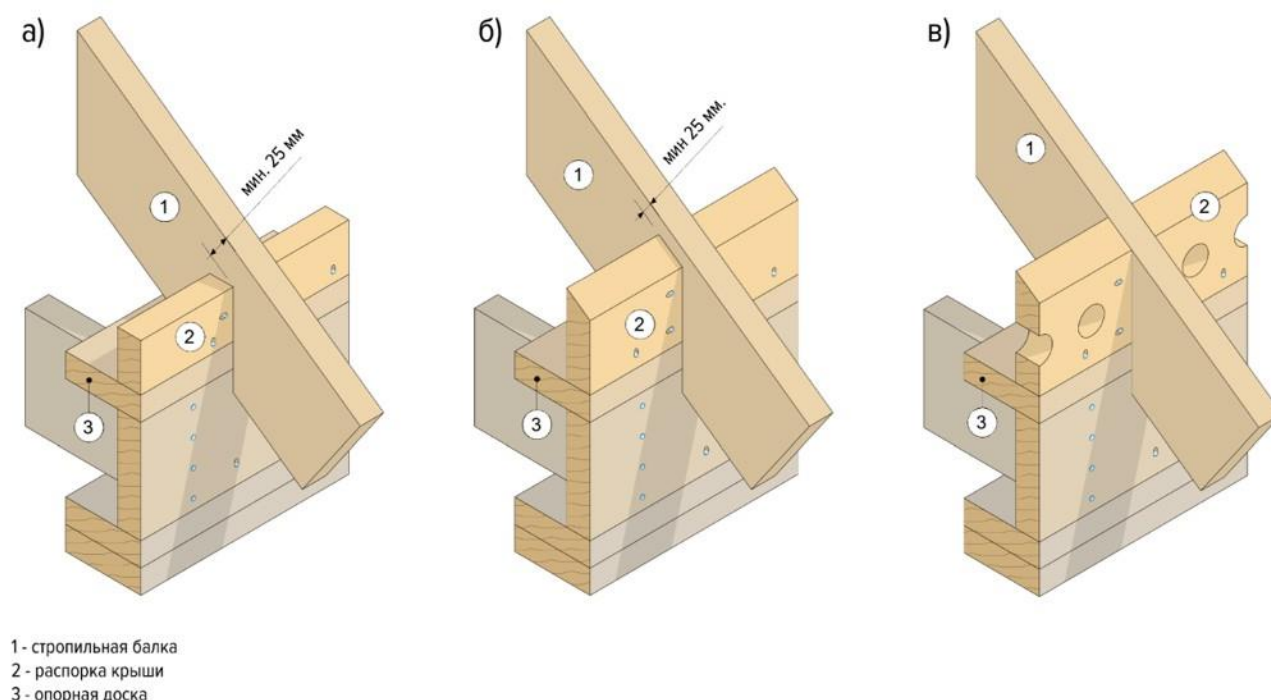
Организация вентиляции в карнизном узле опирания стропил неутеплённой крыши
